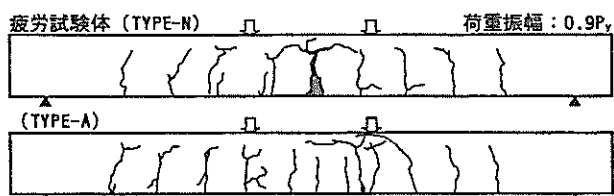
ひび割れ発生状況図 (疲労試験)
